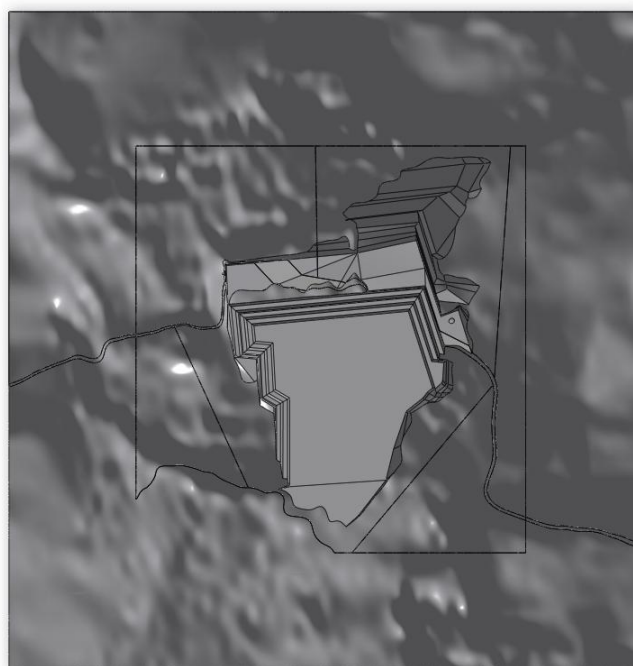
Modello geometrico 3D progetto di coltivazione a 15 anni – vista planimetrica
